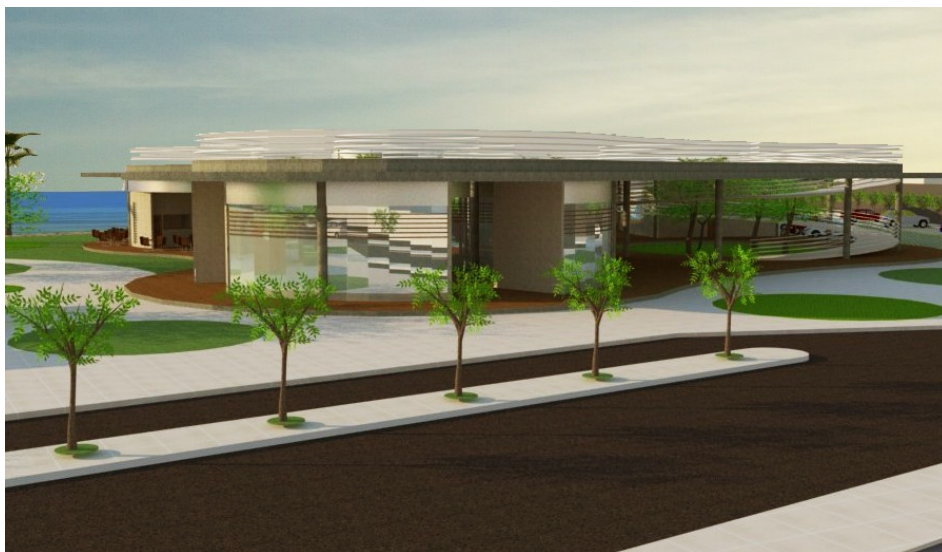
Lojas na entrada do centro comercial e rampas de acesso a laje jardim
